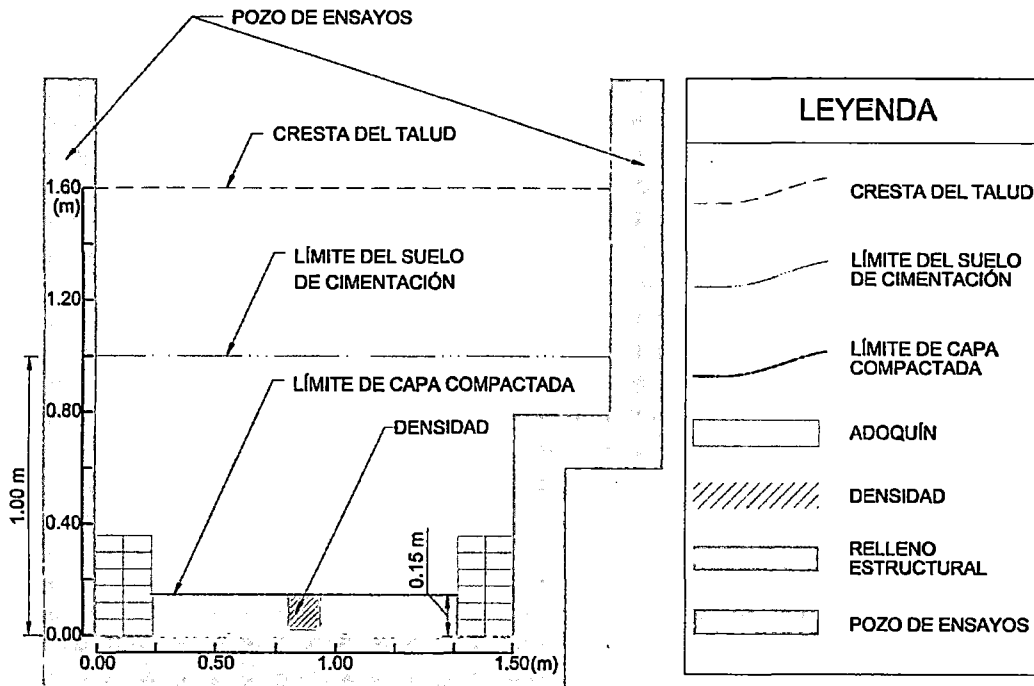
Sección transversal del pozo de ensayos, ensayo SC N°1 - Suelo de cimentación
